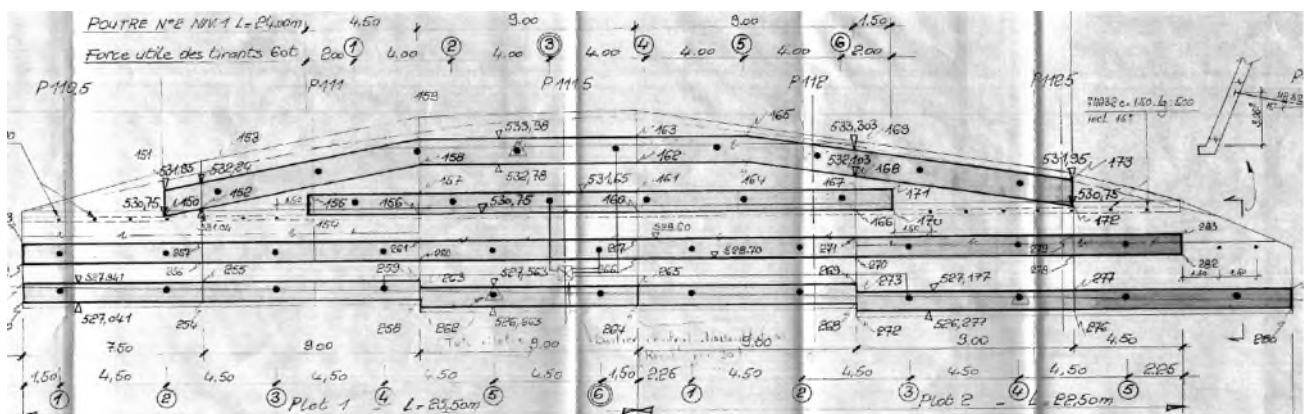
Exemple de plan de coffrage d'un mur tiranté
